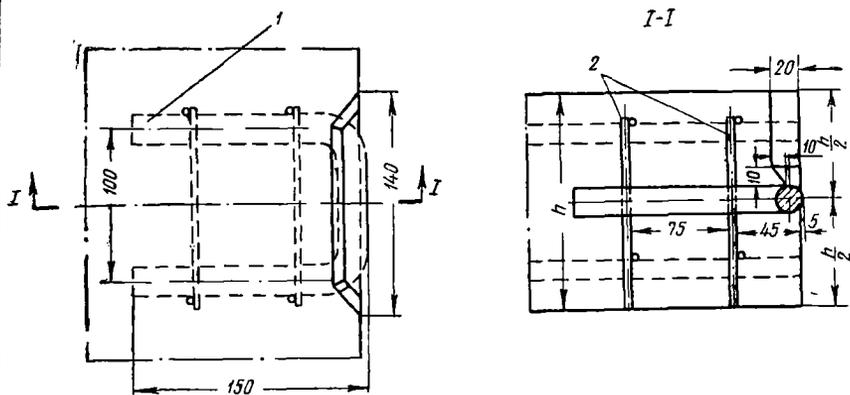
Конструкция стыкового соединения плит сборных покрытий:
